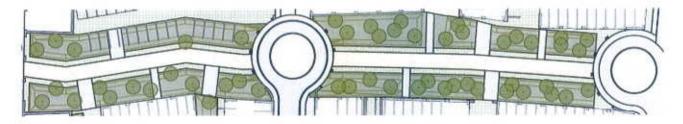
Principe de traitement paysager de la promenade piétonne : à l'axe de l'aménagement se trouve la canalisation gaz. De part et d'autre on retrouve des noues plantées et des accès aux ilots
